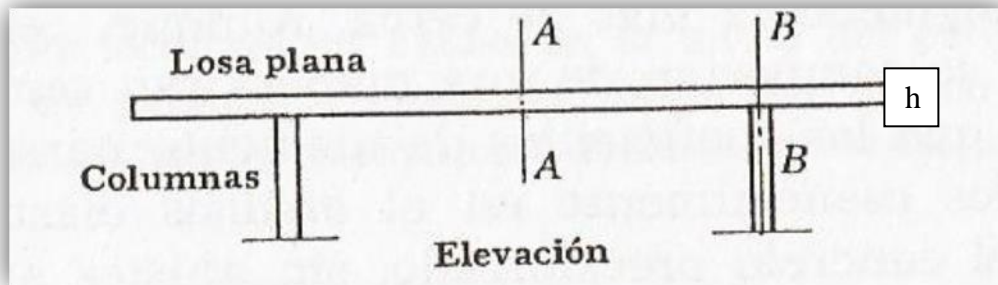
Vista de una losa apoyada sobre 2 columnas.
